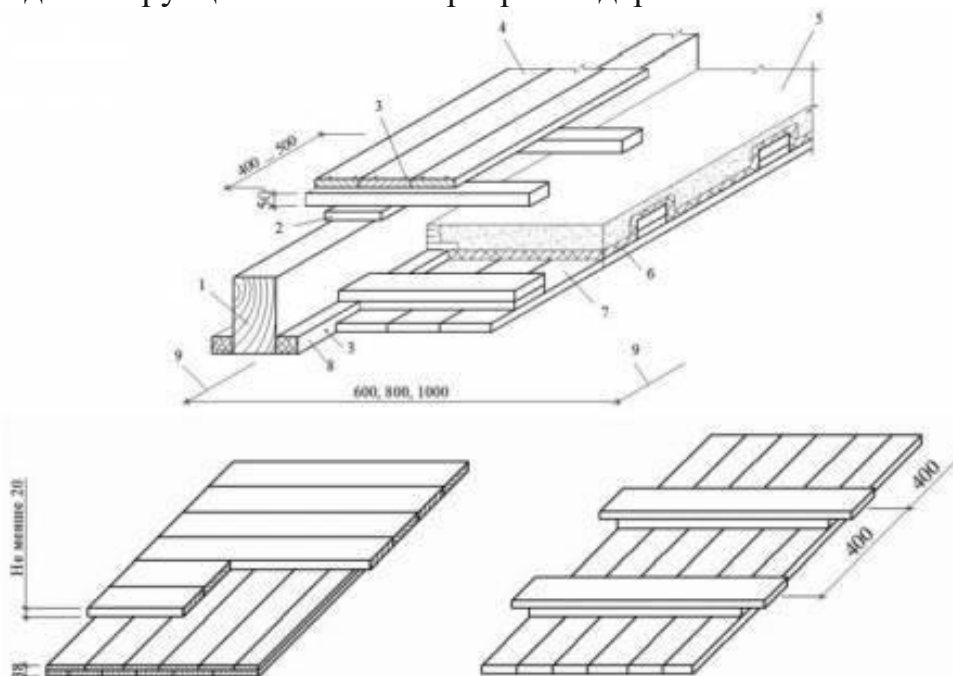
Конструкційна схема перекриття дерев'яними балками
